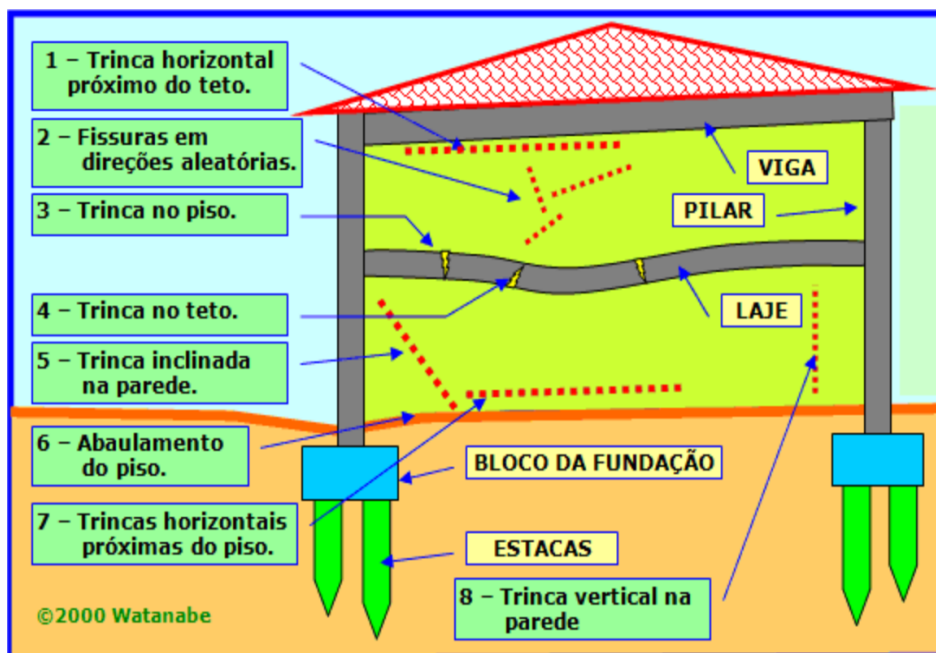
Principais tipos de fissuras ou trincas encontradas em uma edificação
